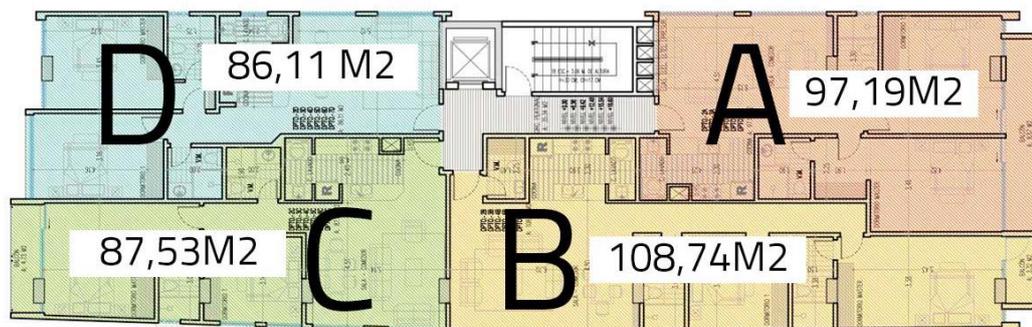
Planta Tipo. Fuente: Constructora Estrella Viteri
